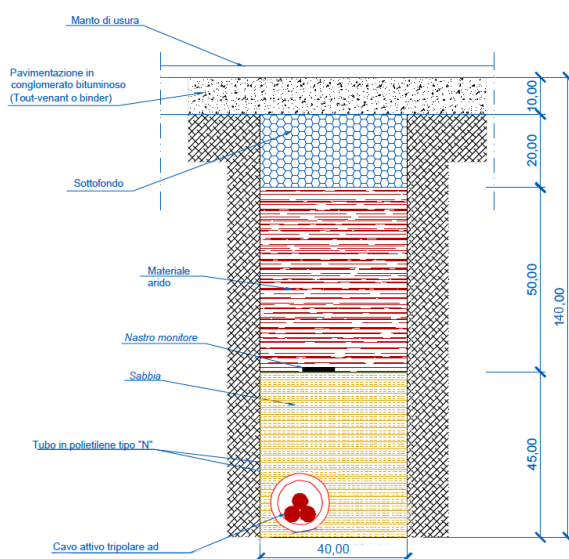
Sezione tipica di posa della linea in cavo su sede stradale
